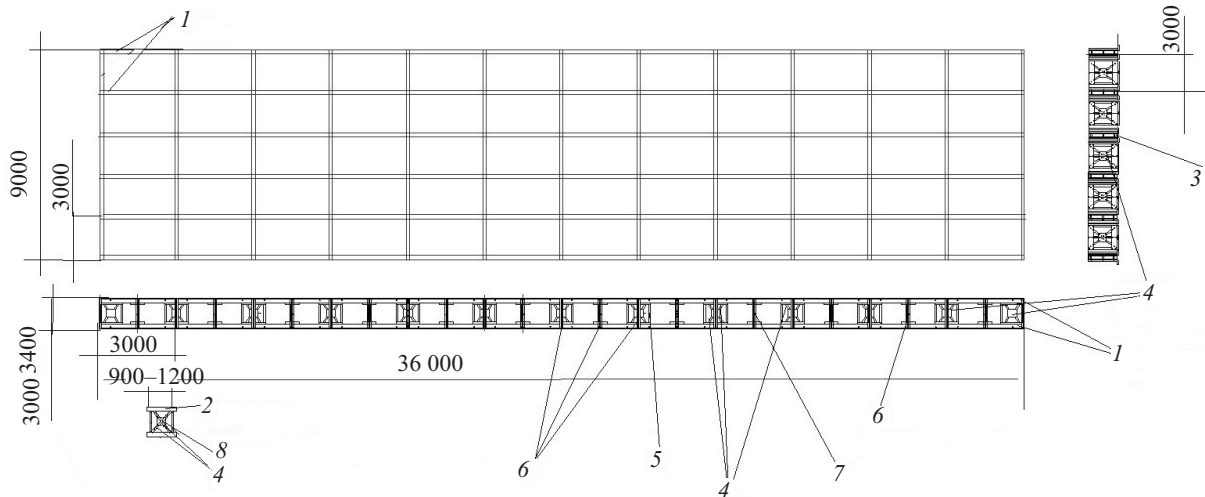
Перекрестно-балочная конструкция: 1 — пролетная балка (швеллер 400–500 мм); 2 — швеллер на размер меньше основного, чтобы плотно входить в основную конструкцию; 3 — стойка балок лонжеронов, вид сбоку; 4 — вставной элемент усиления из двух перекрещенных подкосов, квадратных труб, сверху на сварную часть которых приварена пластина; 5 — стойки квадратные 150 × 150 × 8; 6 — накладной элемент усиления, устанавливаемый с двух сторон; 7 — стойка складная; 8 — металлическая пластина толщиной около 1 см
